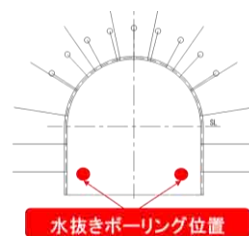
水抜ボーリング施工位置 写真-5 水抜実施状況
